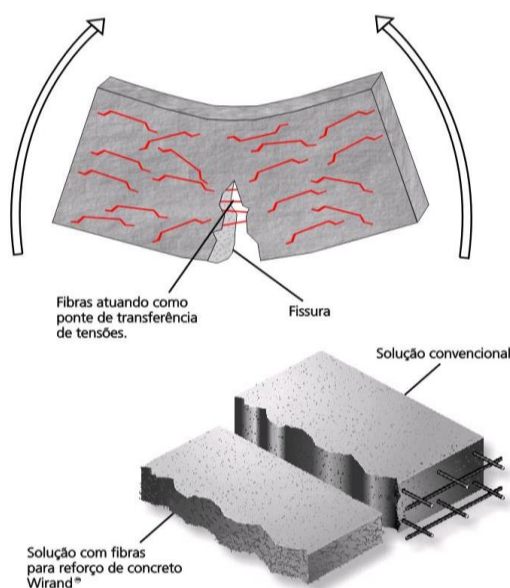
Fibras de acero reforzando hormigón (Maccferri, 2002-2007).
